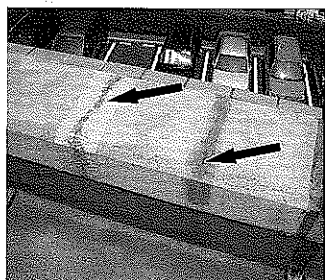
パラペット天端のUカットシートひび割れ補修
